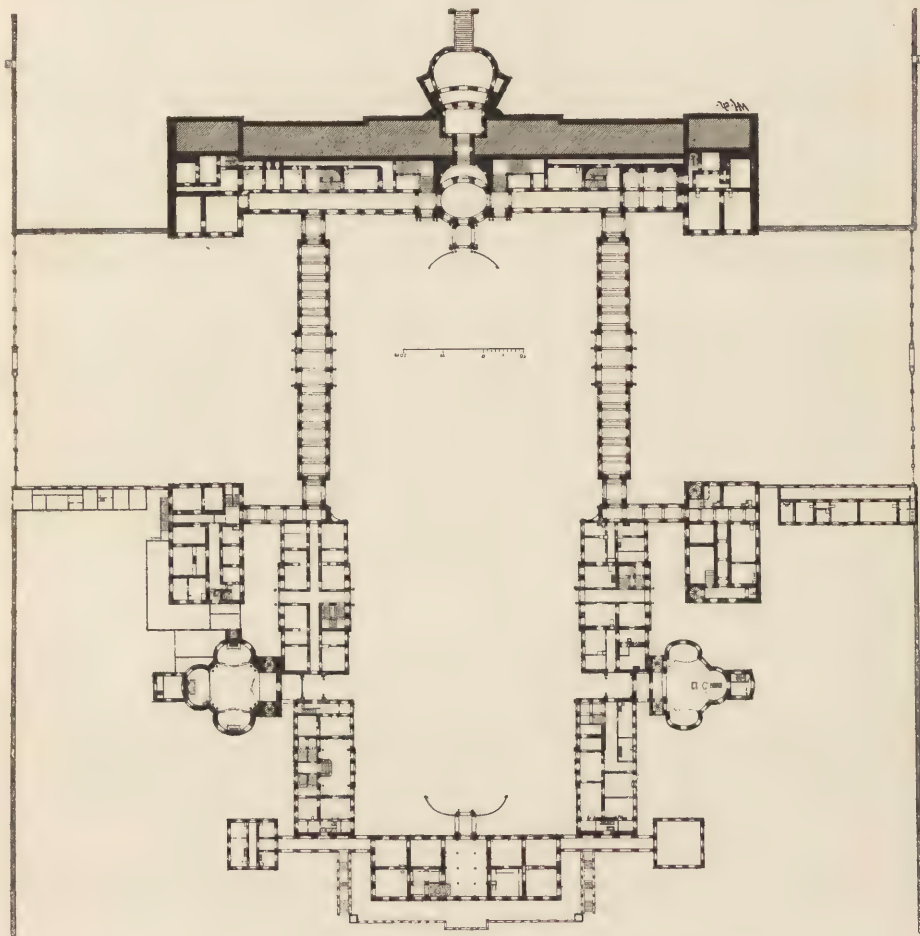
Schloss Ludwigsburg. Grundriss des Erdgeschosses.
